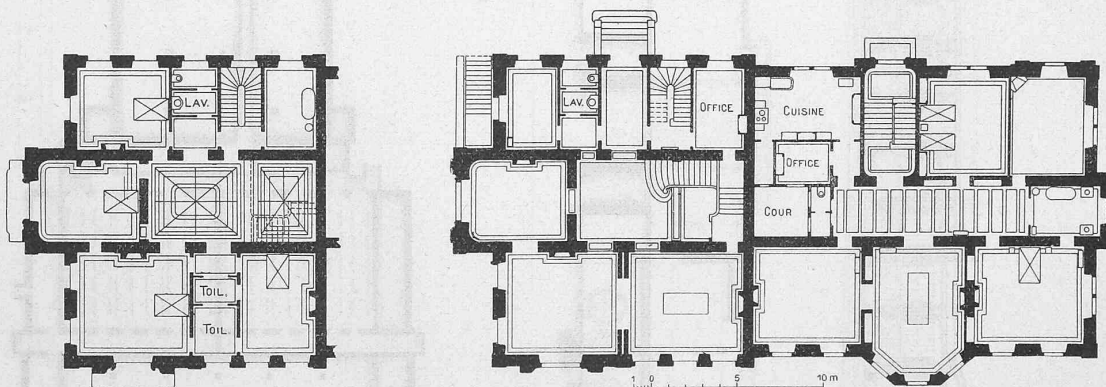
et 12. Pavillons d'habitation. — Plan du rez-de-chaussée et plan du premier étage de l'aile ouest.
